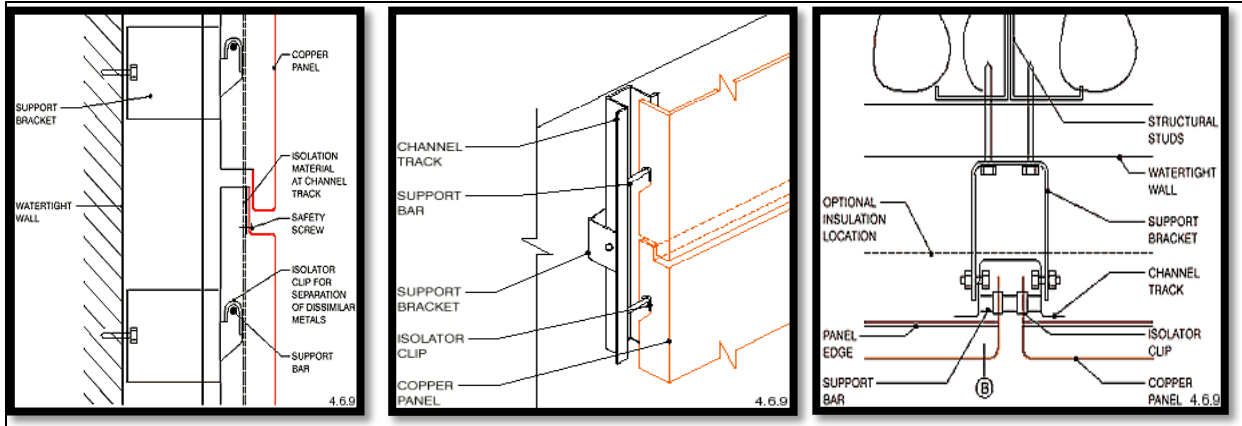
مسقط أفقي ومقطع راسي وتفصيل تشطيبات الخارجية والمعالجات بالمبني
